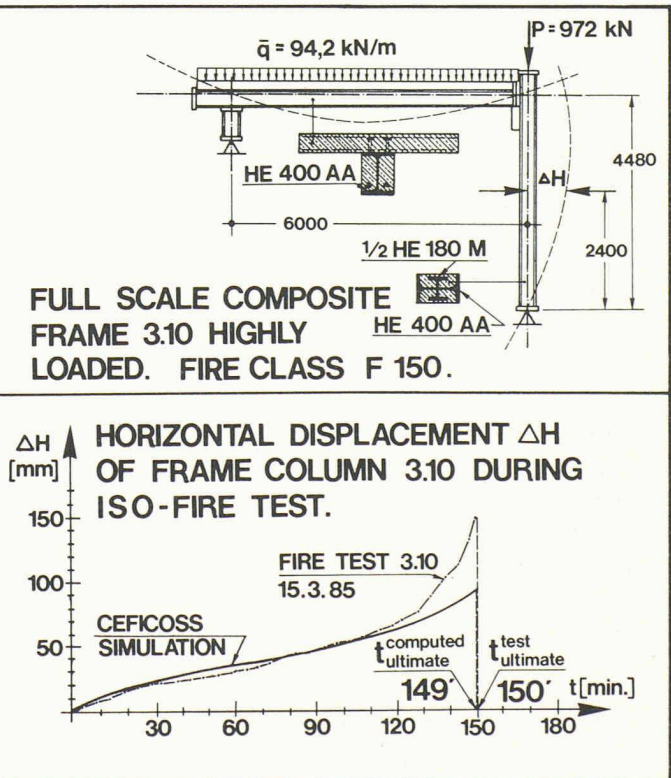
Colonne et poutre du type de cadre testé avec déformation latérale de la colonne.
